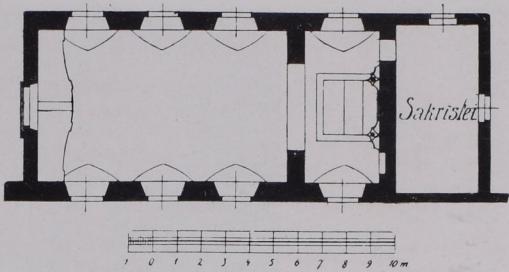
Hallein, Salinenkapelle, Grundriß 1:300 (S. 138).
